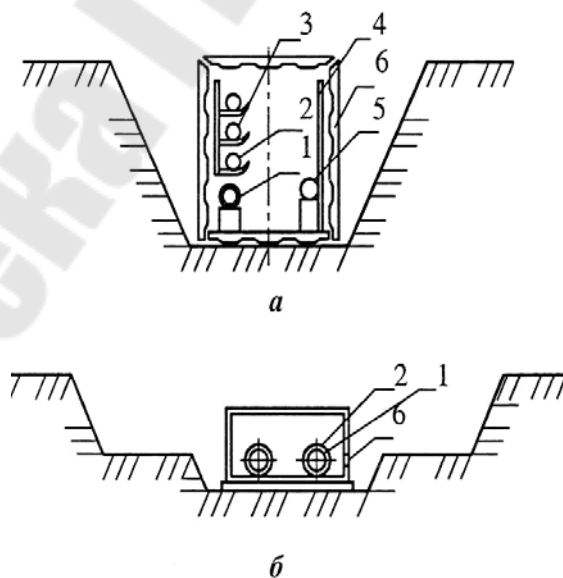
Подземная прокладка трубопроводов в каналах: а- проходном, б- непроходном; 1 - подающая теплосеть, 2 - обратная теплосеть, 3 - трубопроводы горячего водоснабжения, 4 - электрокабель, 5 - водопровод, 6 - сборные железобетонные конструкции
